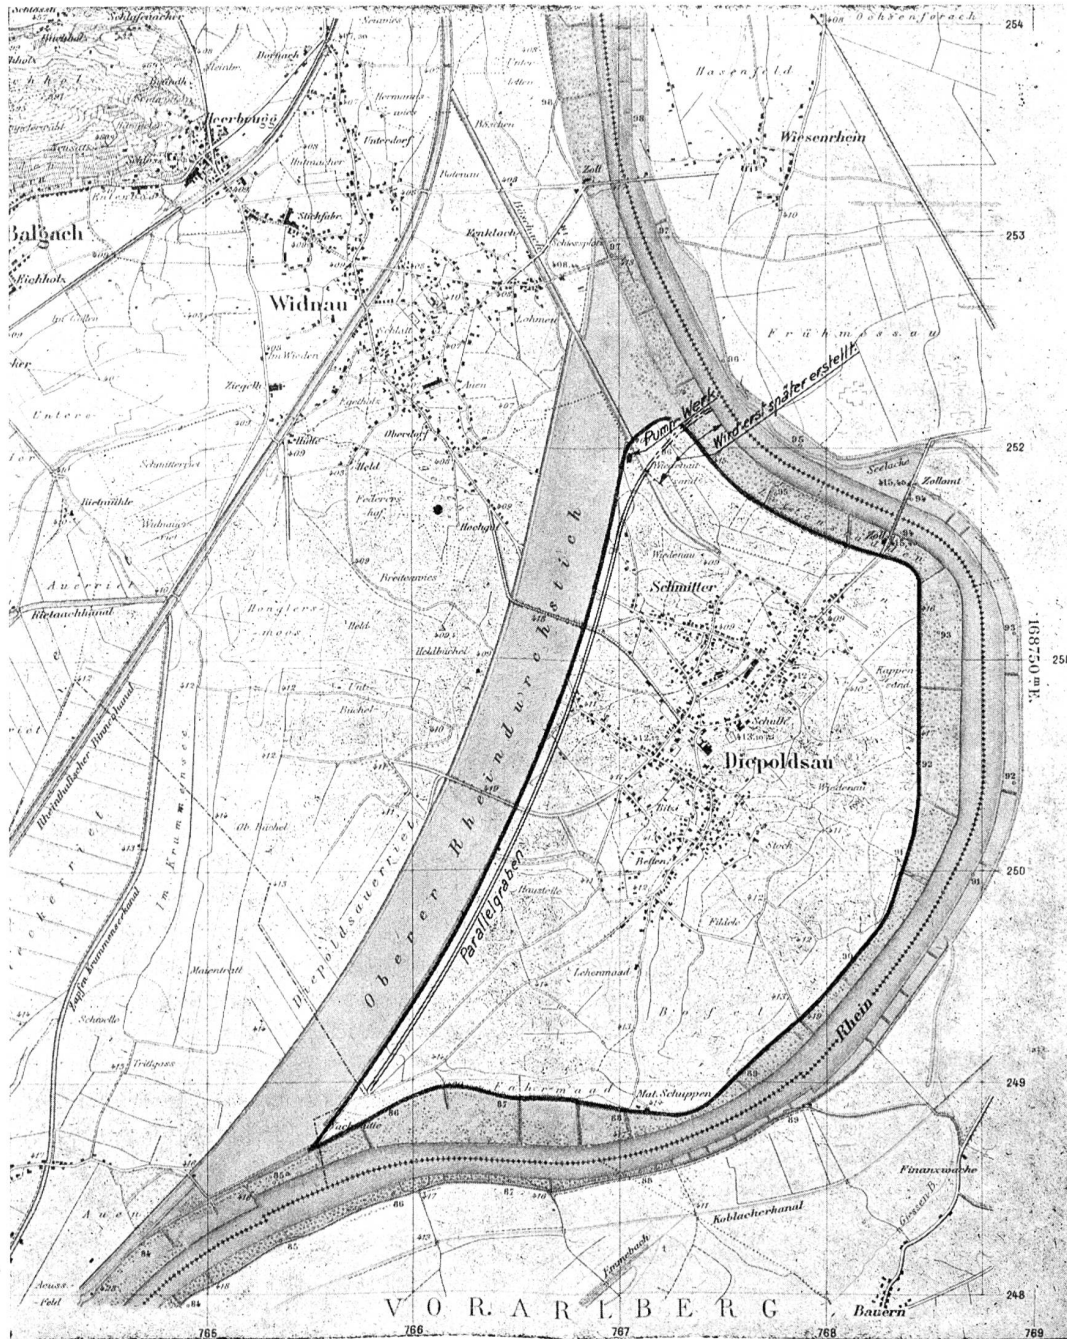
Pumpwerk Diepoldsau. Pumpenanlage zur Beseitigung der Diepoldsauer Gewässer. Uebersichtsplan. Maßstab 1:35 000.
